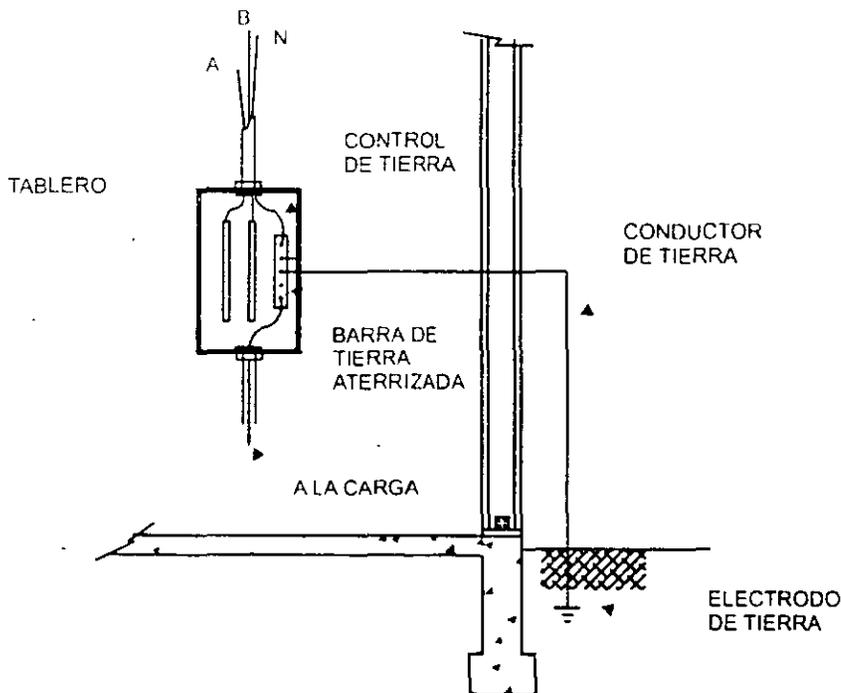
CONEXIÓN A TIERRA DE EQUIPO Y ESTRUCTURA
